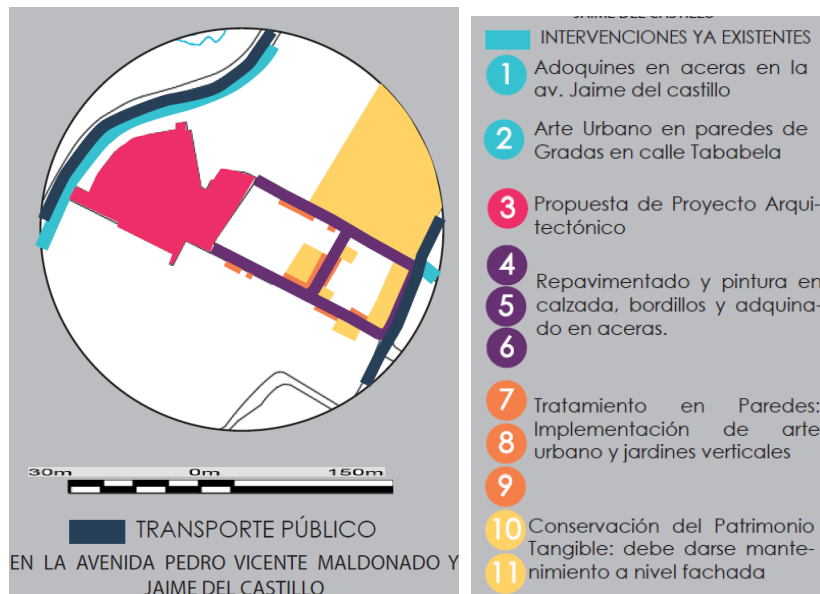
Propuesta de Plan General para el contexto del proyecto
